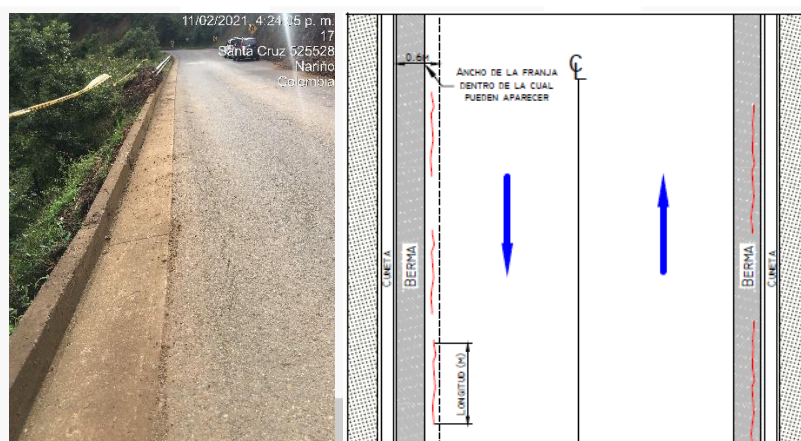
Fisuras de borde – PR24+680.
